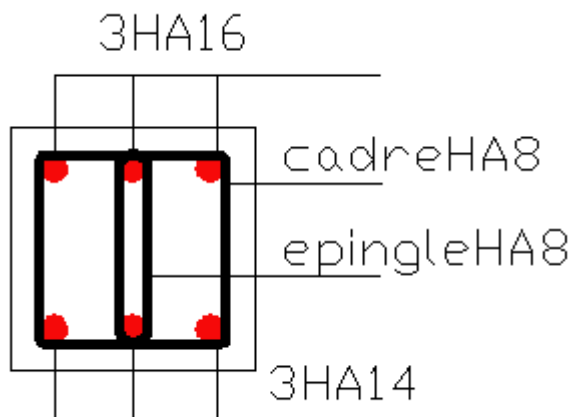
Schéma ferrailage de la poutre palière de type 1.
